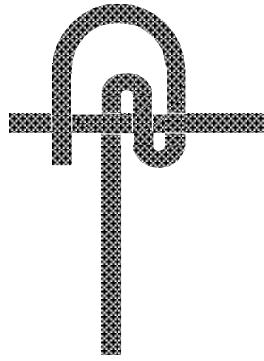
Подготовка свободного конца соединительного арматурного каната к
